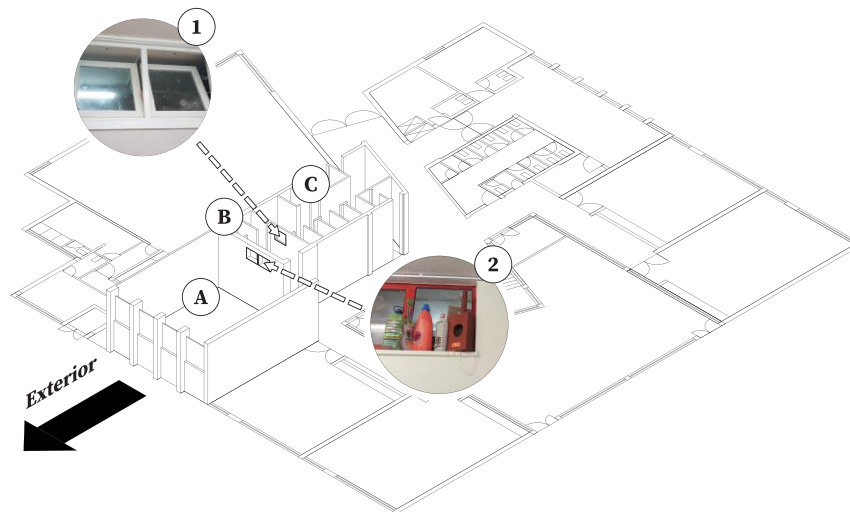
Planta do Bloco A (Adaptado de projetos Fornecidos CMM).
